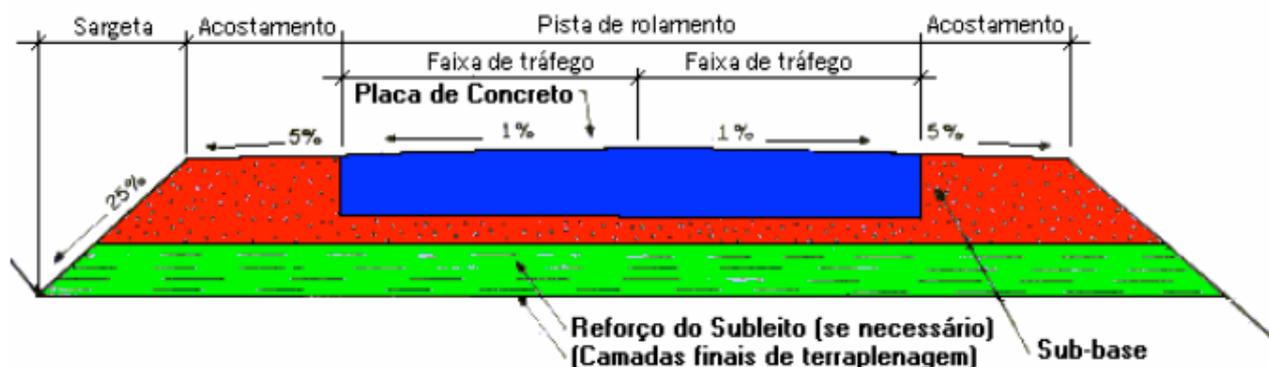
Seção Transversal Típica de Pavimento Rígido
